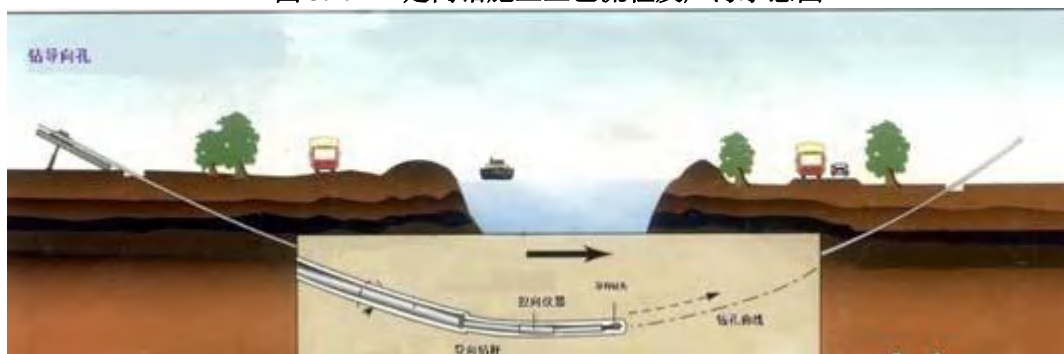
定向钻穿越施工钻导向孔过程断面示意图
